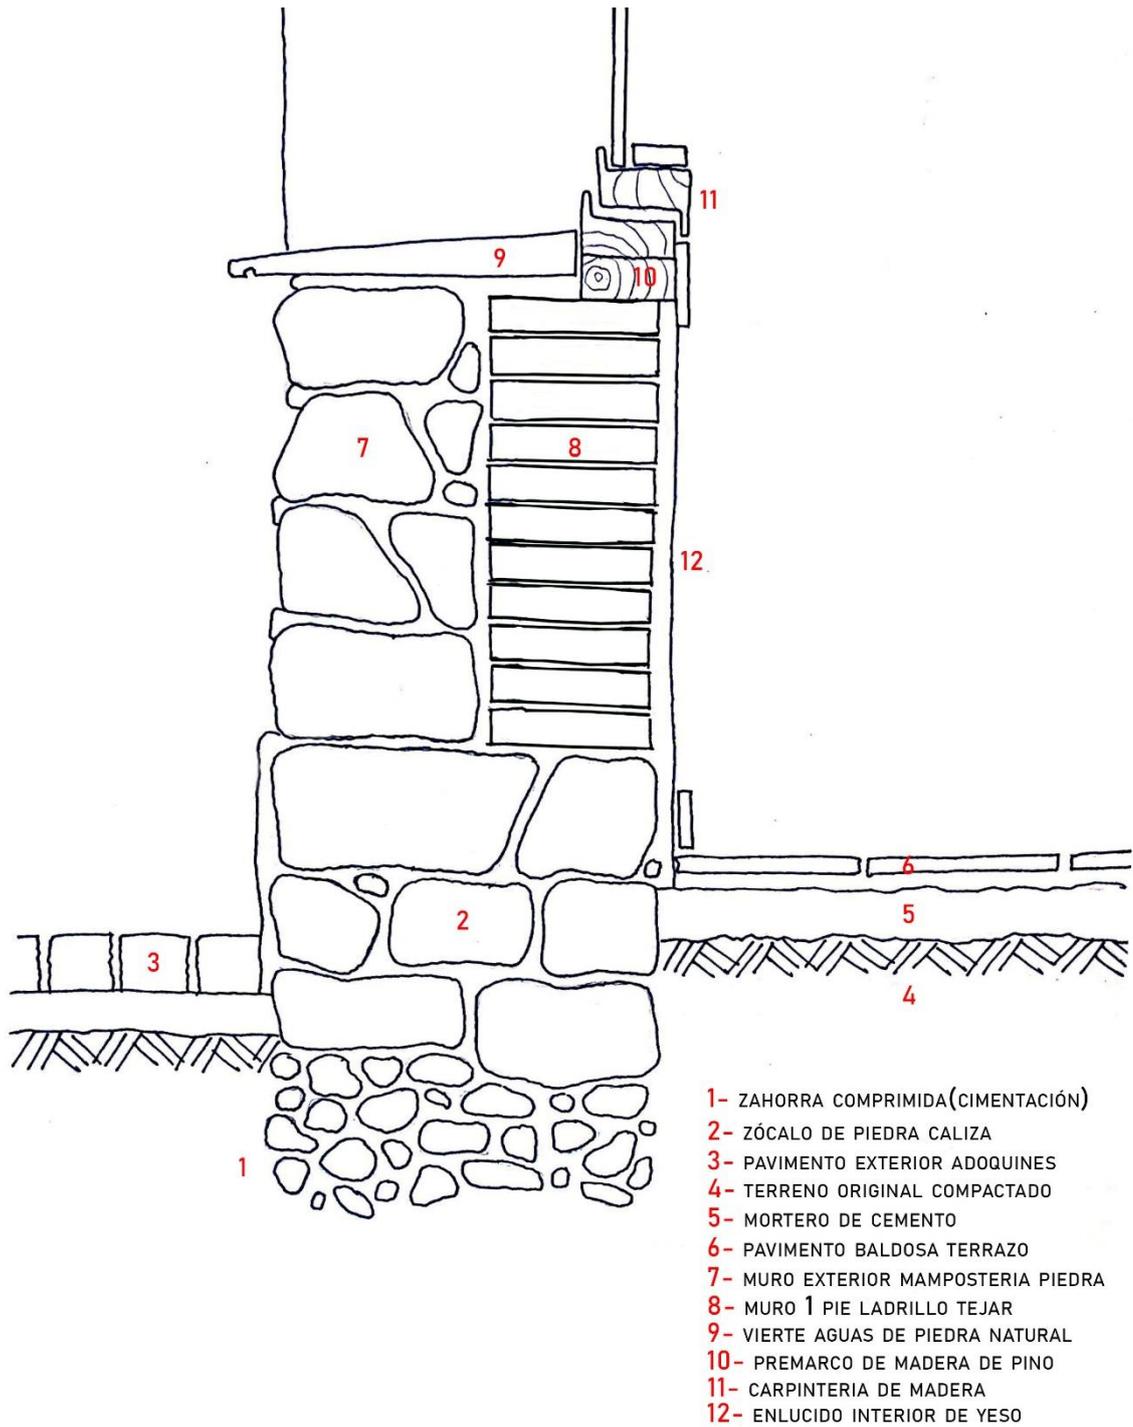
Detalle constructivo original – Cimentación – Arranque de la fachada – Huevo inferior
